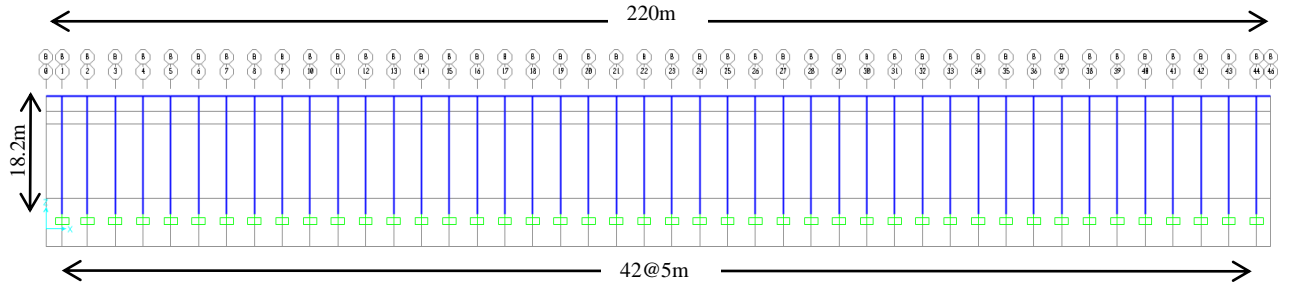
Vista en elevación del plano B de geometría, paralelo a plano X-Vertical.
